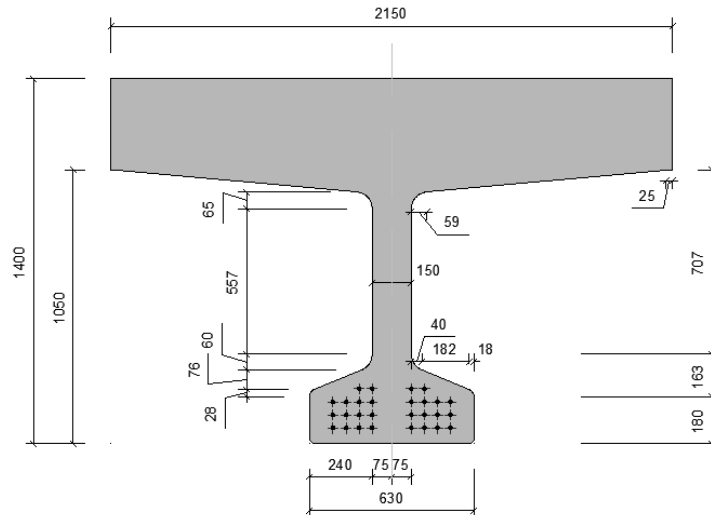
Características Geométricas da Viga 110 VTS Isolada com Laje de Betão
